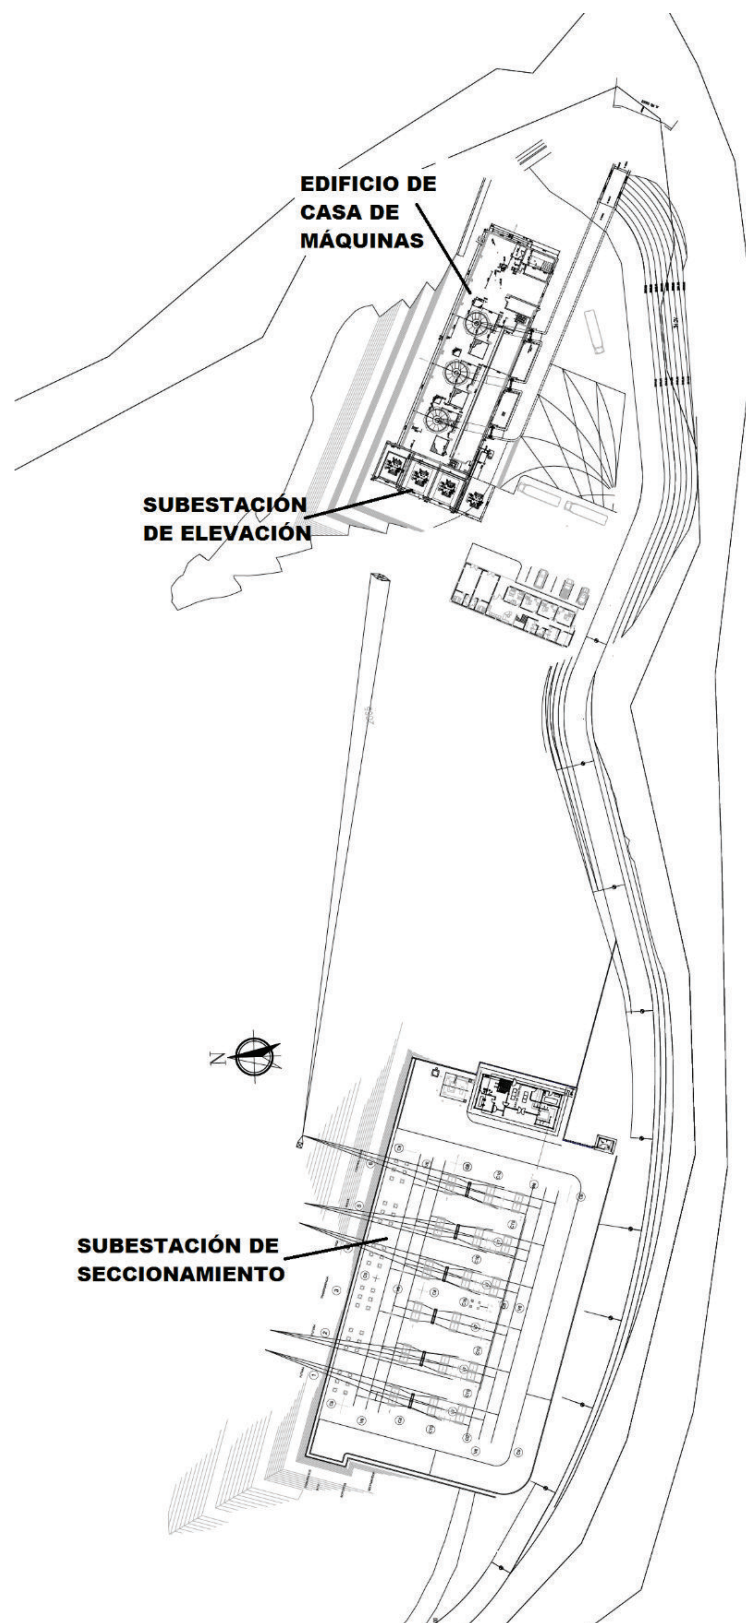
Ubicación de las subestaciones de seccionamiento y elevación de la Central Quijos ^[45]
